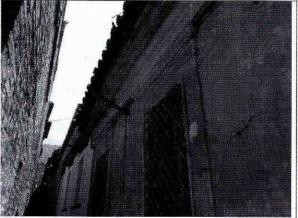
Deterioro en los elementos de madera que conforman el alero frontal.
